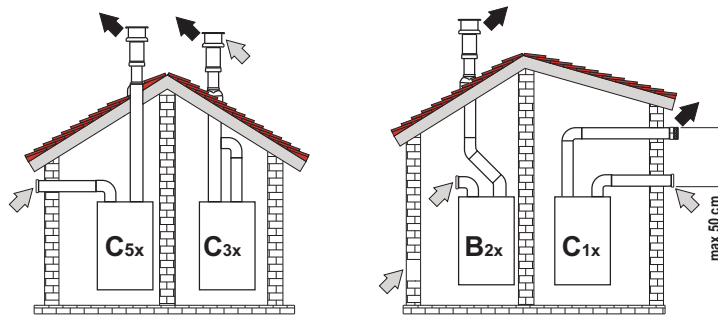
Esempi di collegamento con tubi separati (⇨ = Aria / ⇨ = Fumi)
